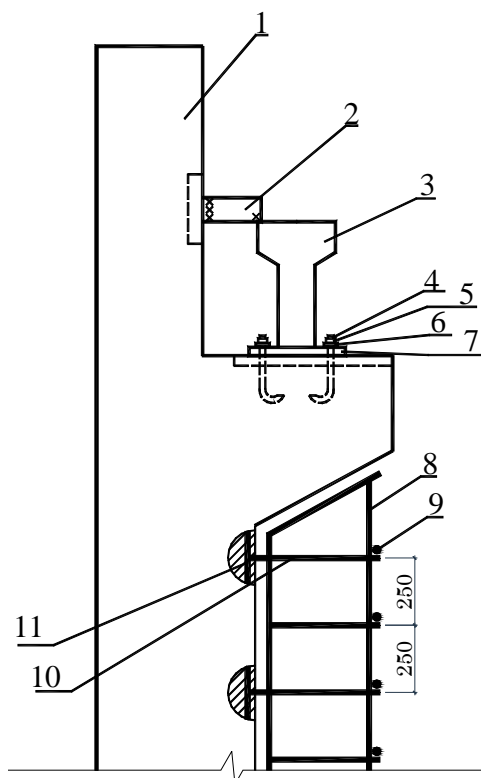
Вузол кріплення арматури підсилення до колони:
